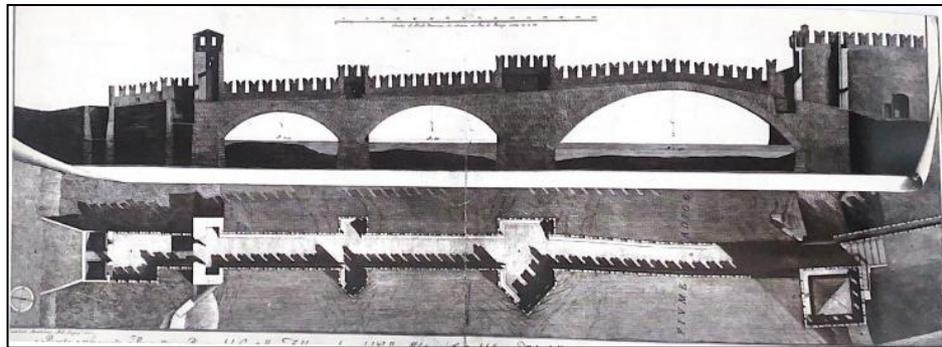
Vista lateral e planta baixa da Ponte Scaligero
